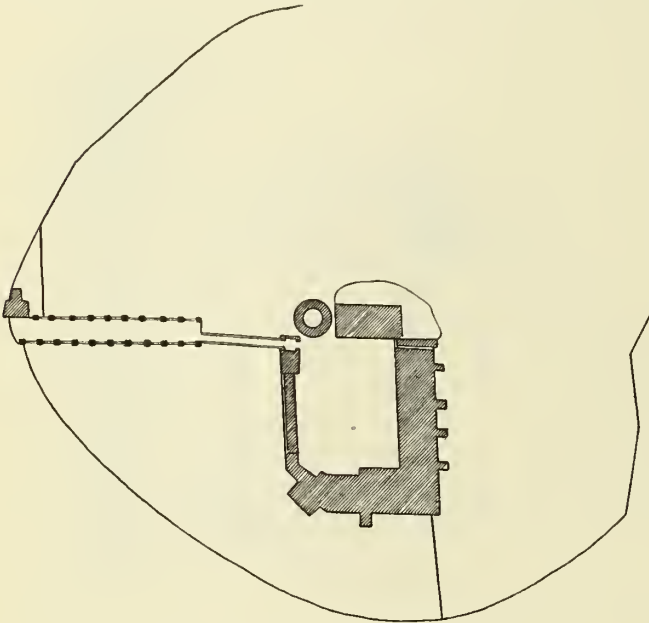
Dinslaken. Grundriss des Schlosses.
